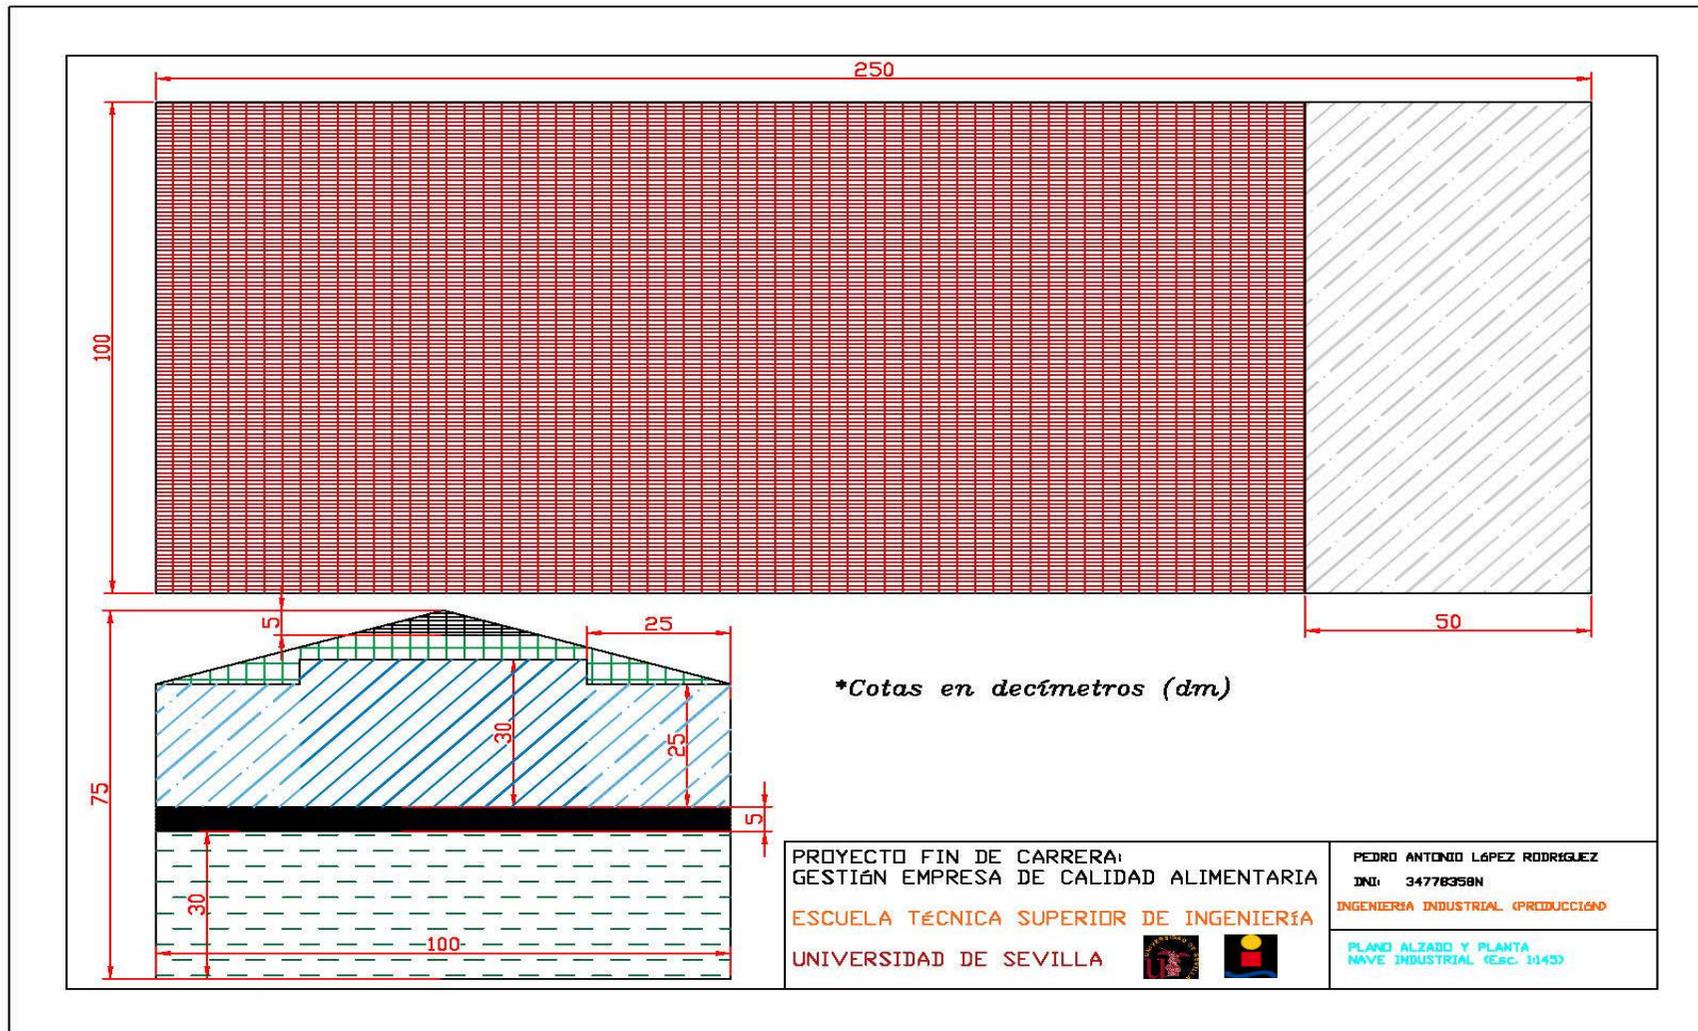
Plano Alzado y Planta Nave Industrial
